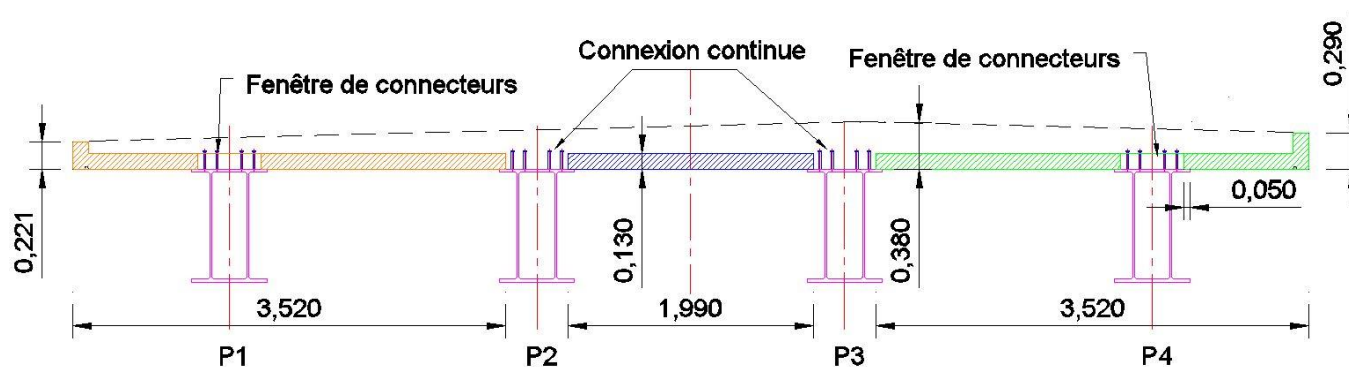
Coupe transversale du tablier – Disposition des prédalles
